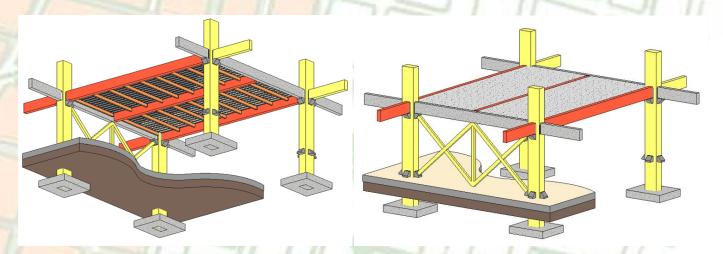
Detalle constructivo de una sección de la propuesta. Fuente: propia.
